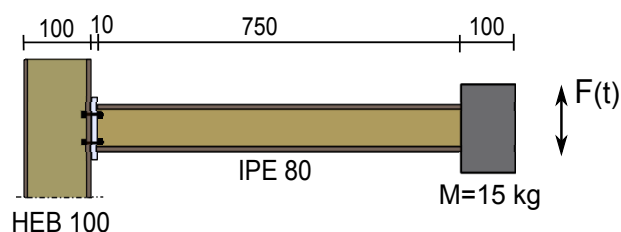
Détails de la poutre encastree-libre testee en flexion (en mm)
